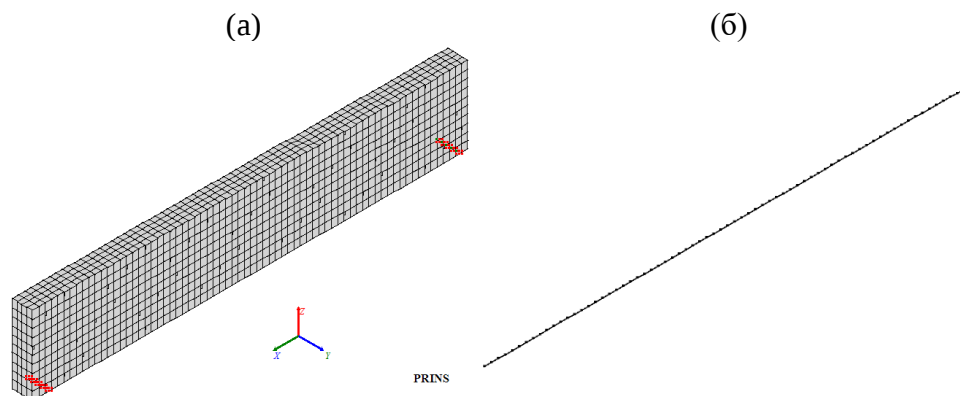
Расчетная схема экспериментальной балки (разработано авторами): а — КЭ модель «тела» балки; б — схема армирования стержневыми КЭ
